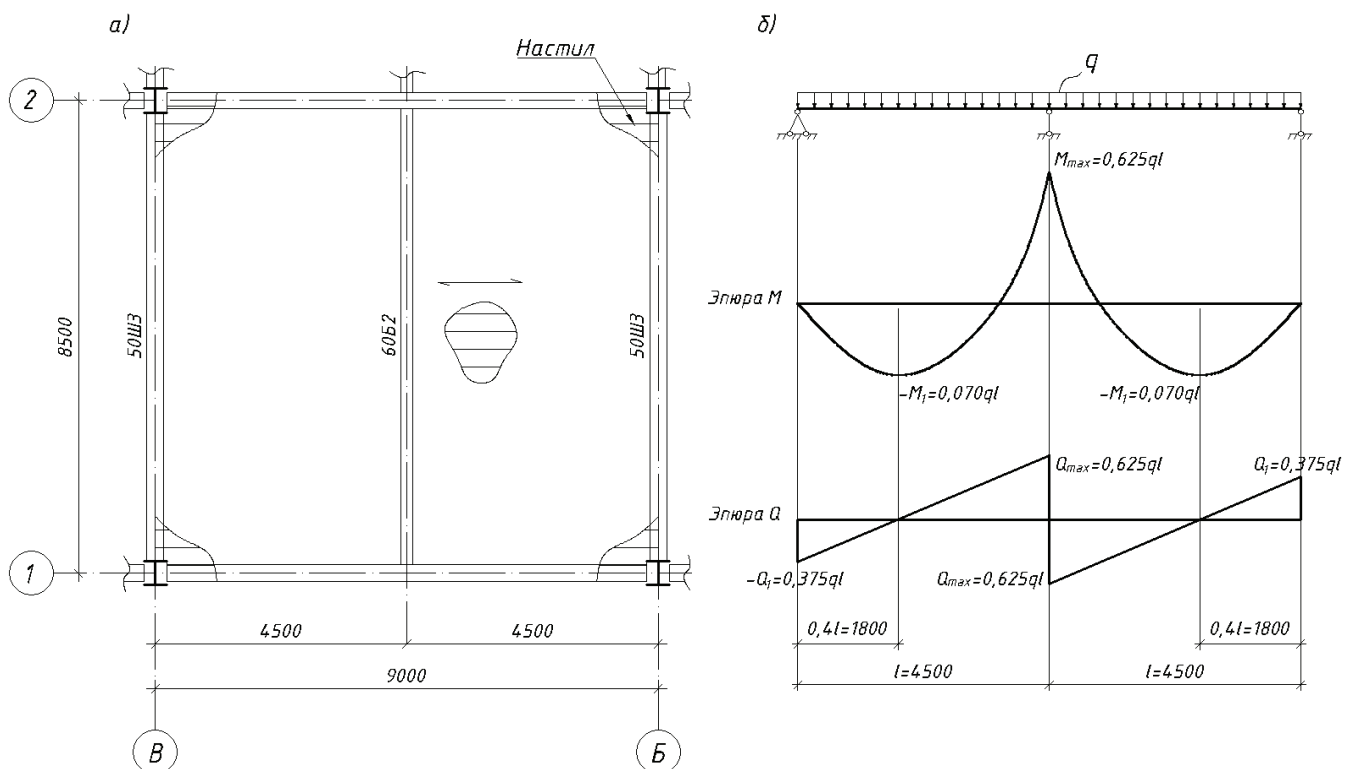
Схемы: а) схема участка балочной клетки; б) расчетная схема перекрытия и эпюры M и Q
